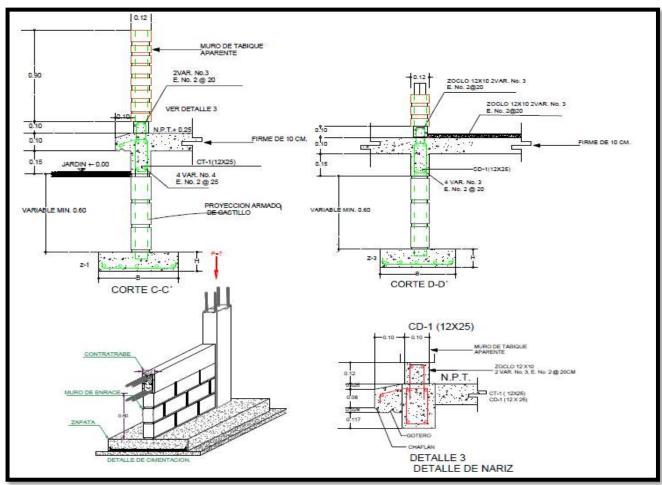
Detalle croquis de cimentación, dimensiones de zapatas y contratrabe, armado, mejoramiento y relleno. Fuente (proyecto ejecutivo.)
